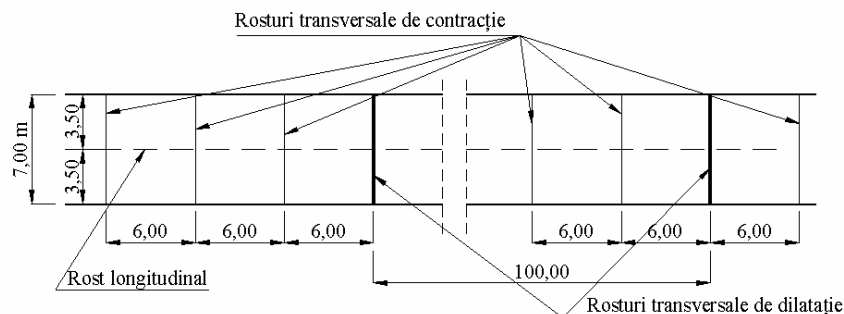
Vedere în plan a unei îmbrăcăminți rutiere din beton de ciment.
